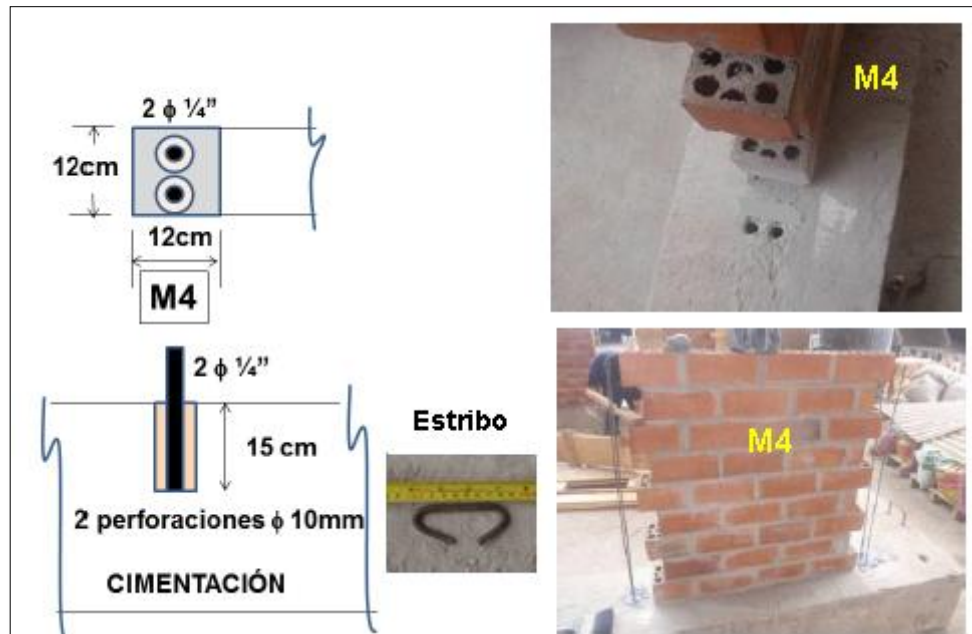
Refuerzo y anclaje en columnas del parapeto M4.
